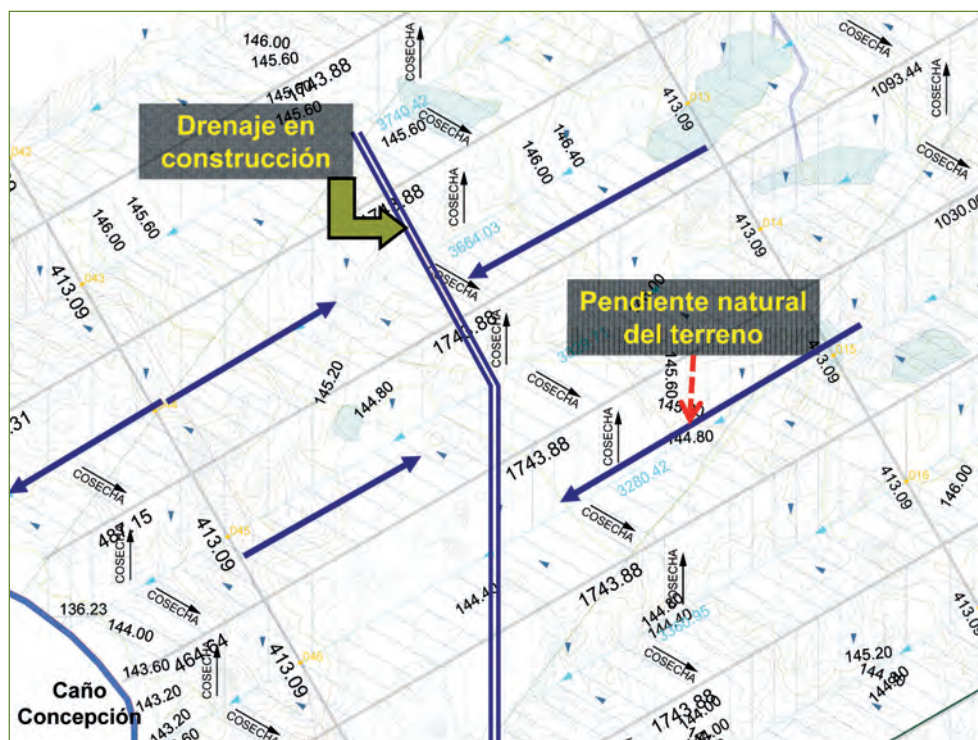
Plano de altimetría y diseño parcial de canales de drenaje.
